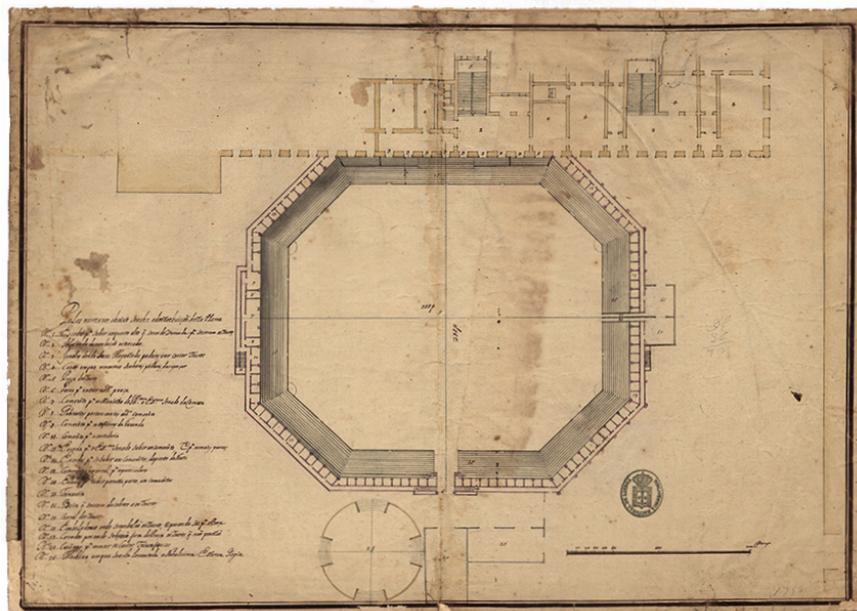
Planta da Praça de Touros, Biblioteca Nacional de Portugal, D. 153 A.
